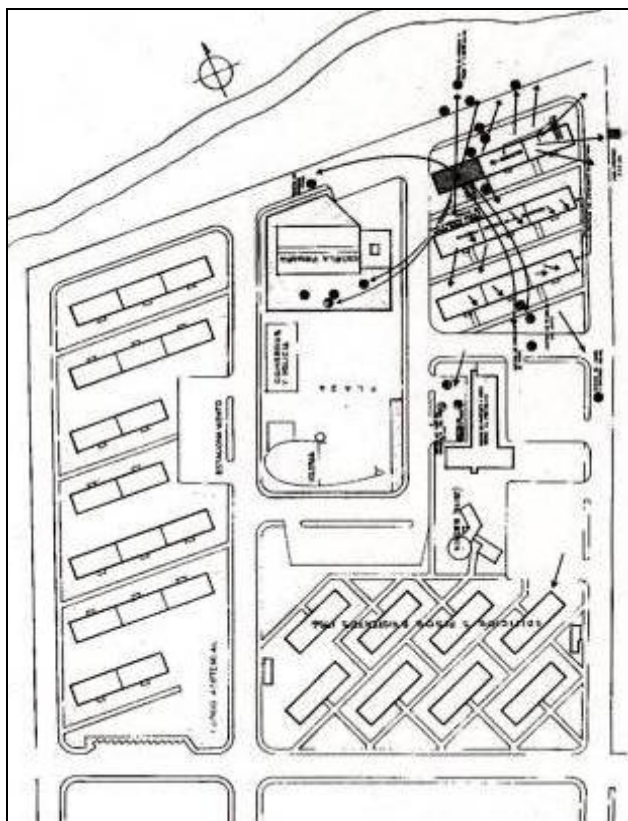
b. UV Zapara. Plano de Conjunto (1957).
